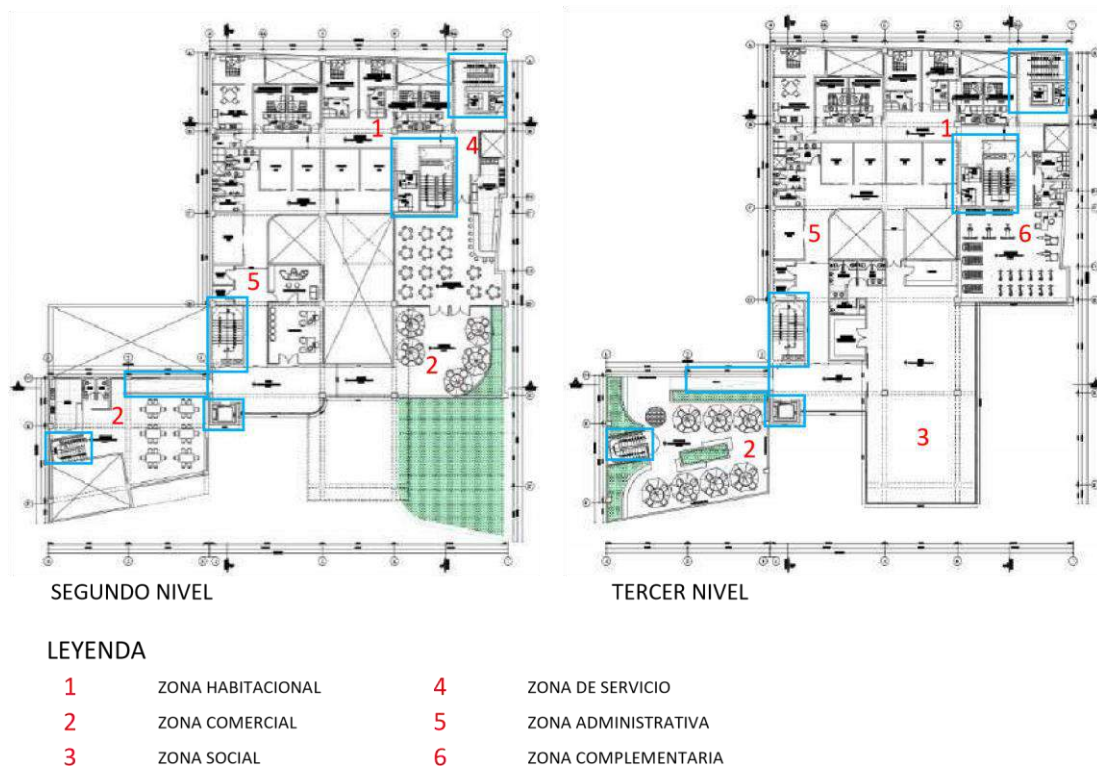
Planos del segundo y tercer nivel del Centro Empresarial. Fuente: Elaboración propia.
